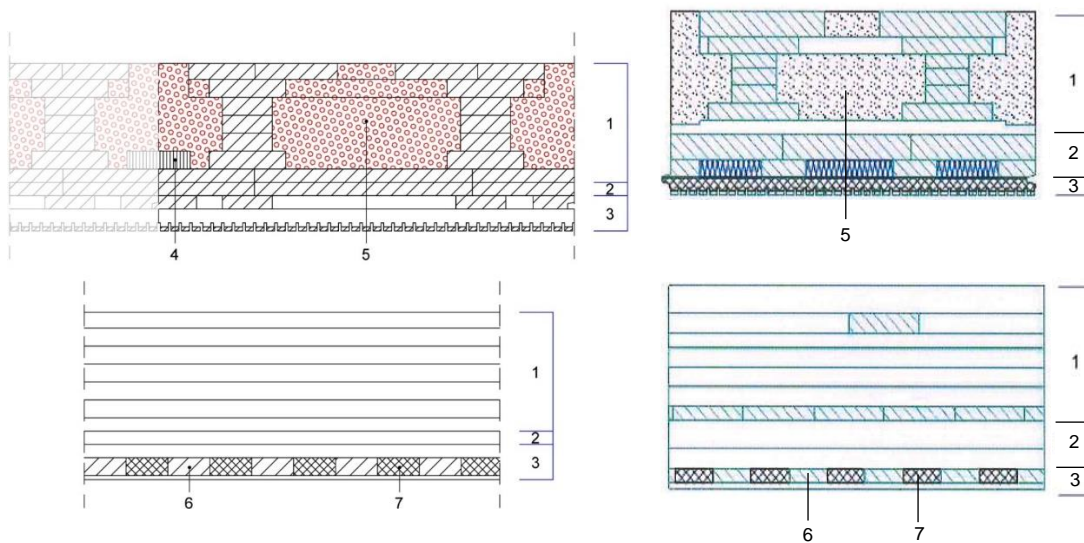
Beispielkonstruktion als Prinzipskizze – allgemeiner Aufbau eines Lignotrend – Deckenelementes (links: Variante 1; rechts: Variante 2)
